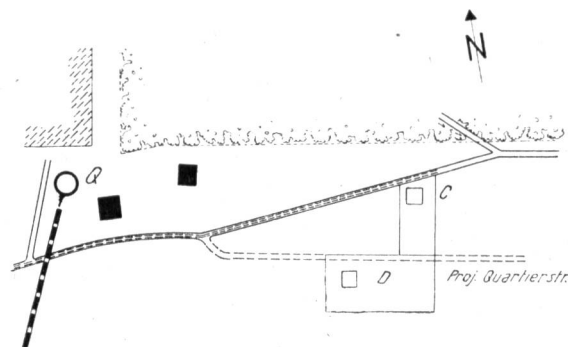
Der Teilüberbauungsplan ermöglicht die Anlage einer neuen Quartierstrasse für die Erschliessung des Bauvorhabens D und der benachbarten Bauplätze.
